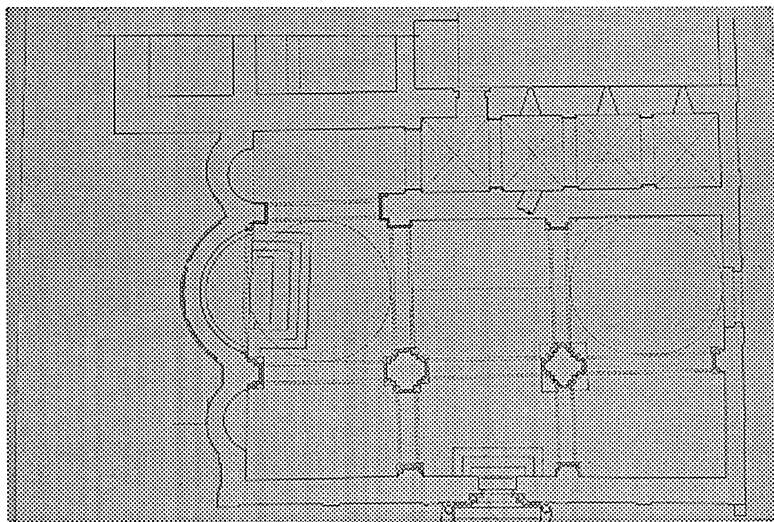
San Leonardo, planimetria della chiesa (rilievo arch. A. D'Ardes).
